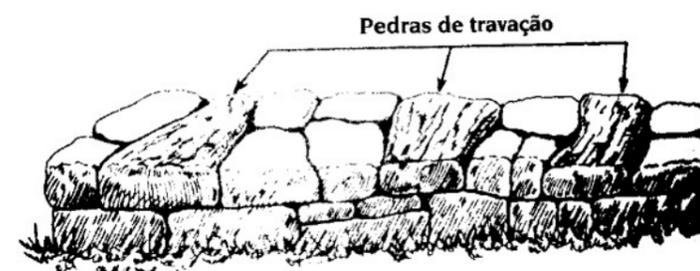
Ilustração de um muro de onde se destacam as pedras de travação. Autor: Vivian (2011)
